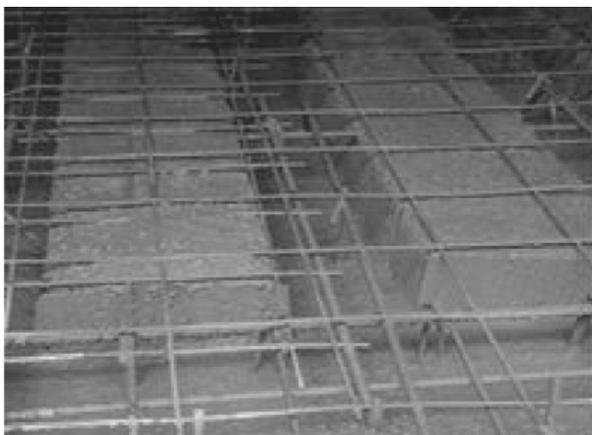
Два этапа бетонирования облегченных перекрытий с использованием полипропиленовых систем
